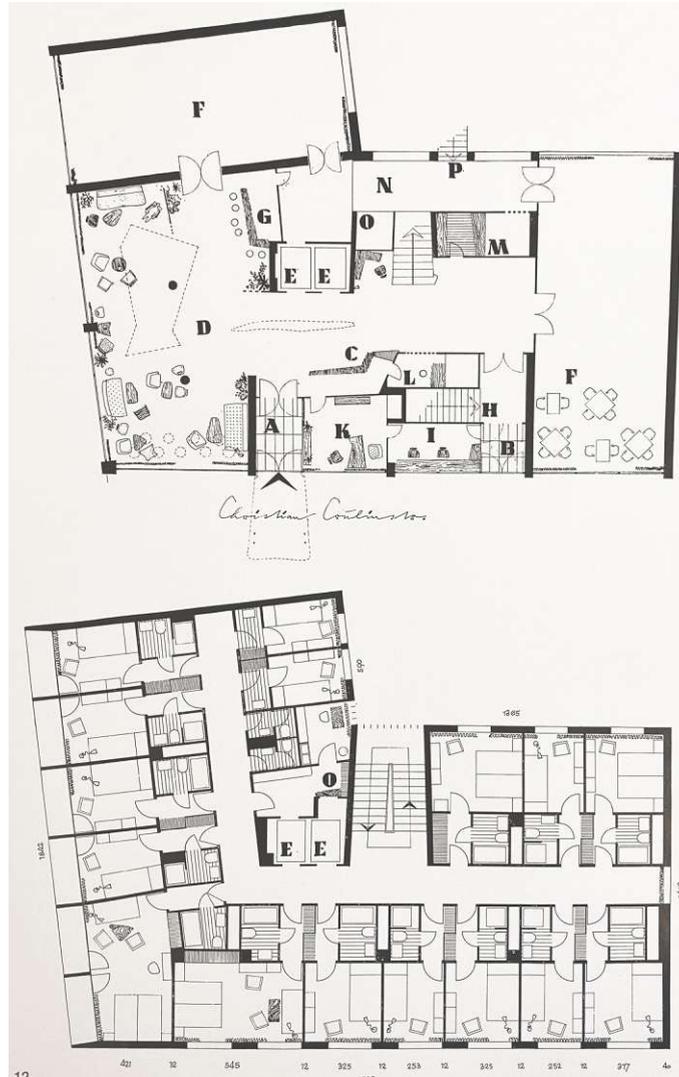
Artur Perotti, Parkhotel Grundrissplan Erdgeschoß, Regelgeschoß, 1951.
